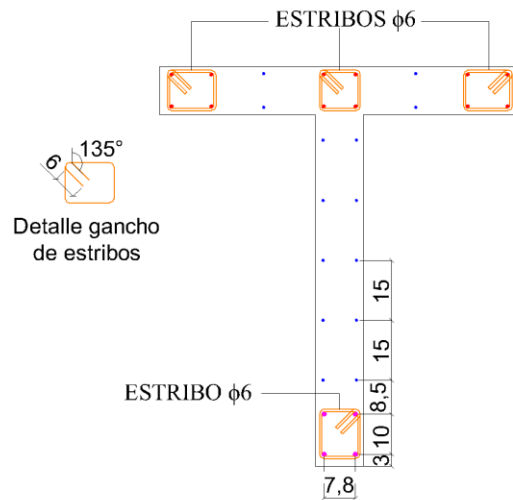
Plano (con vista en elevación) del muro de ensayo ET3.
